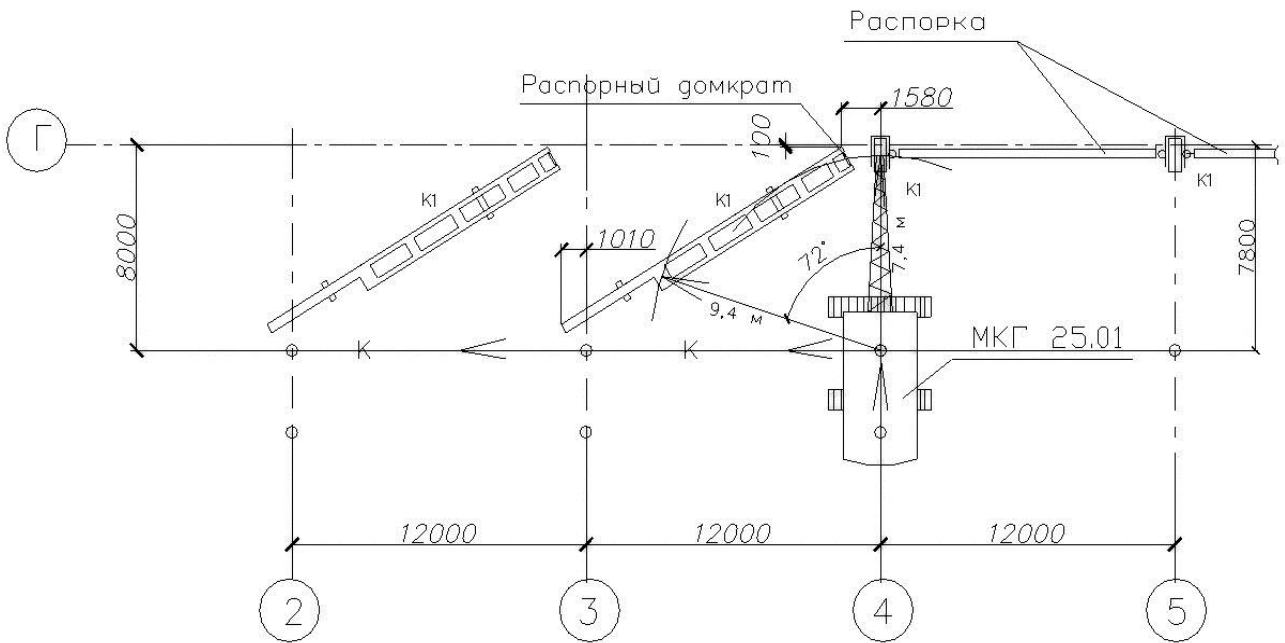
Схема монтажа колонн способом скольжения с изменением вылета стрелы и перемещением крана вдоль ряда колонн
